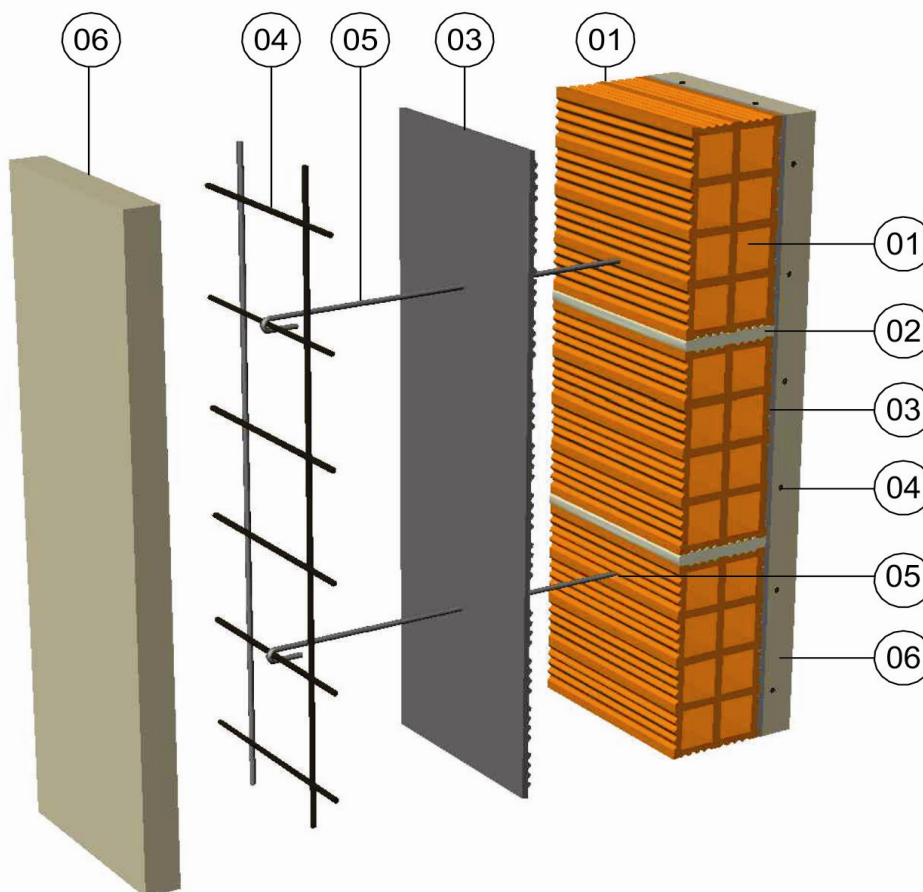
Prisma com reforço de argamassa armada sobre substrato sem revestimento. Chapisco: 5 mm; Revestimento armada 3,0 cm de espessura de cada lado
